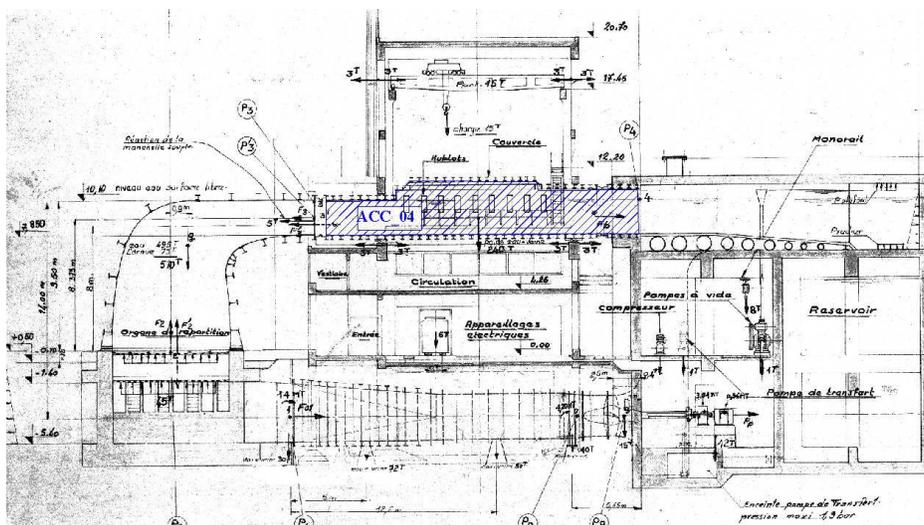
Sezione longitudinale dell'impianto con evidenziata la posizione della camera di prova (al centro nell'immagine)
